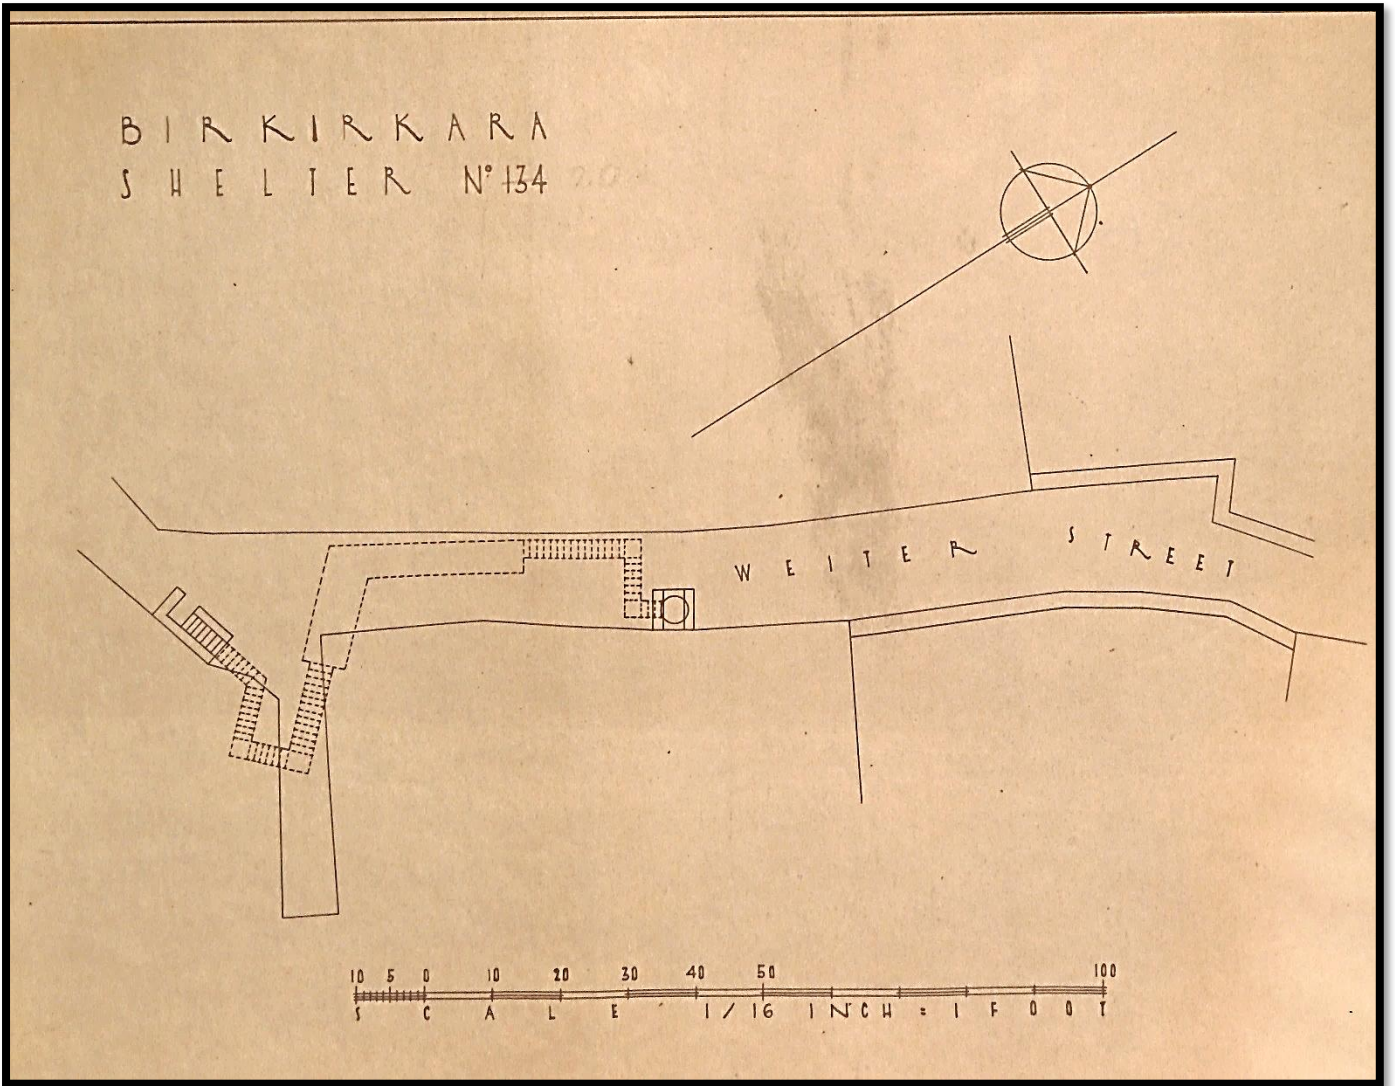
Planta do Abrigo nº 134 (20) "Weiter Street"
